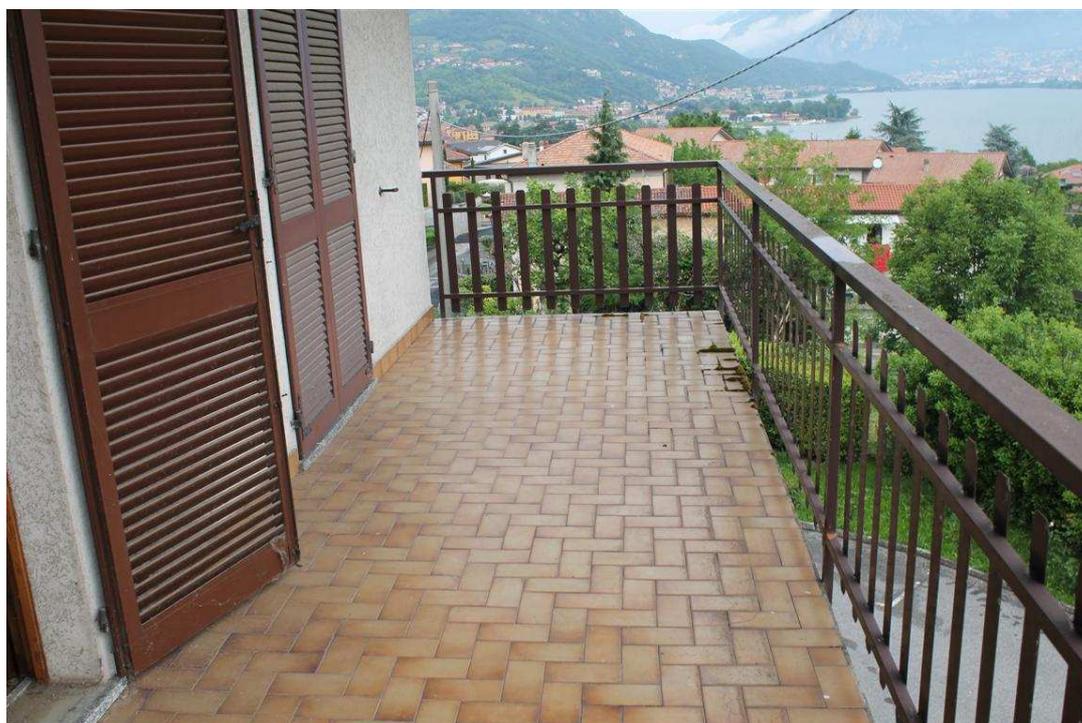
Balcone est – estradosso: infiltrazioni d'acqua in punta al balcone
